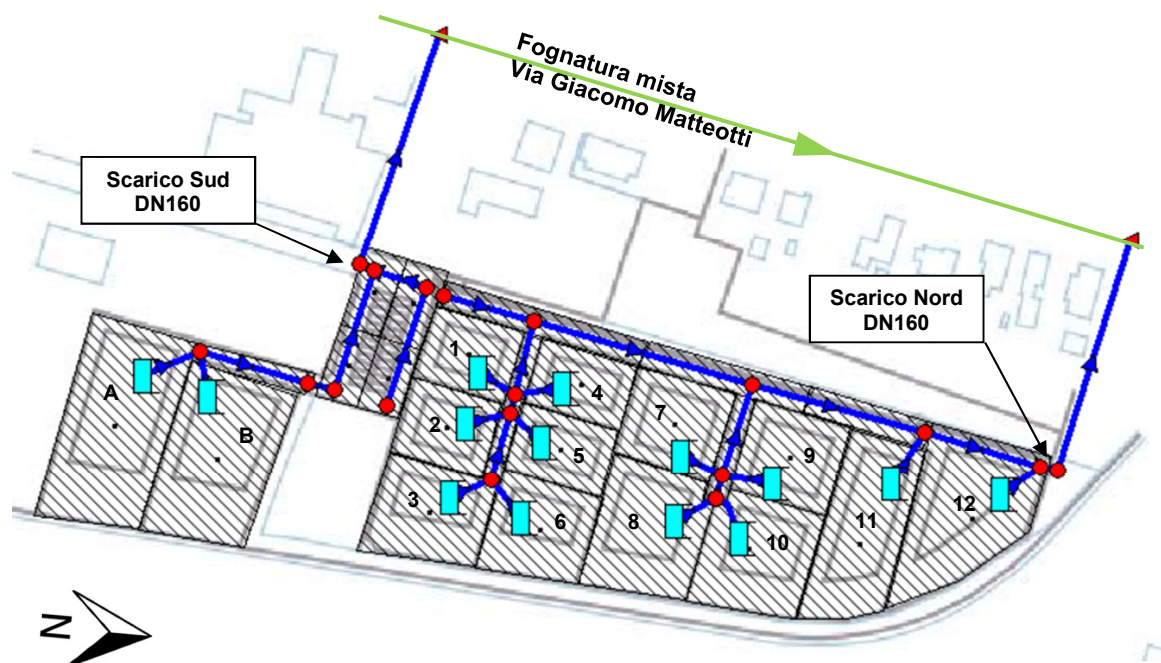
Schematizzazione modellistica della rete di raccolta delle acque meteoriche e individuazione lotti
